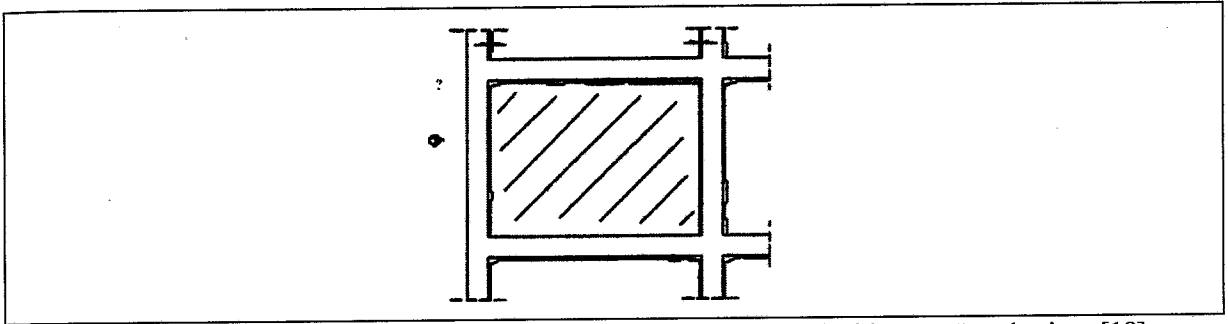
Fissuração em zona de ligação alvenaria estrutura devida a acções térmicas [18]
